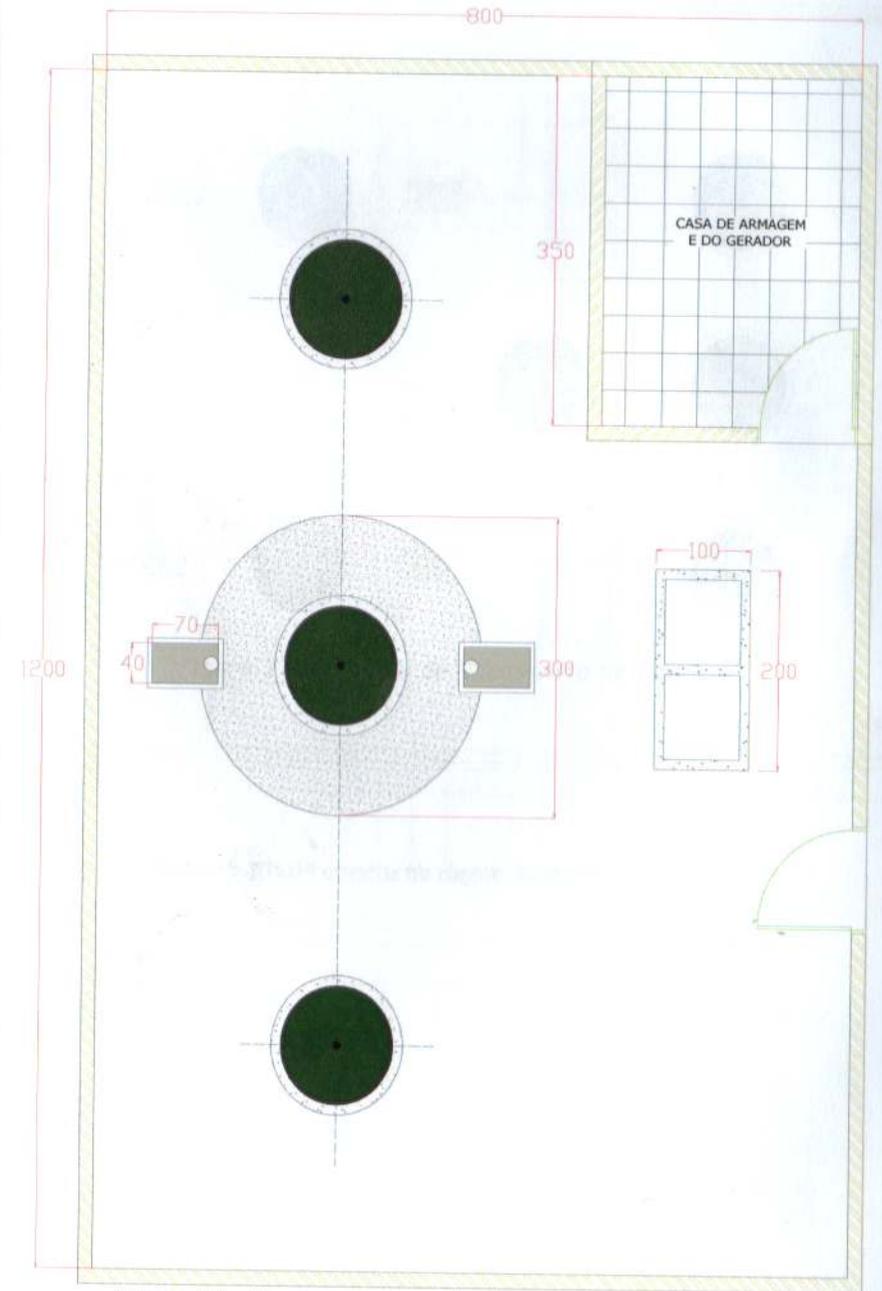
Planta completa do sistema de biogás PUXTIL de 10 m³
